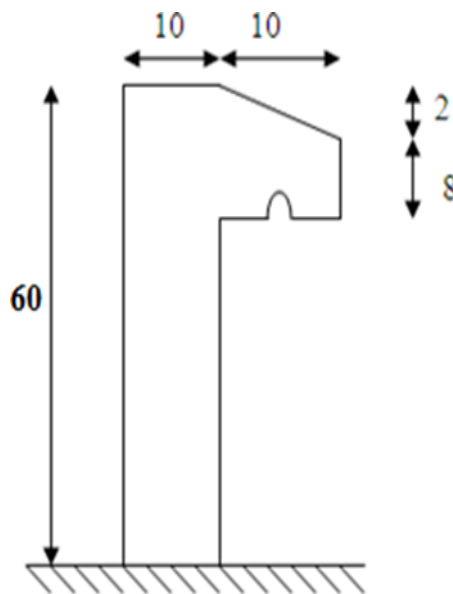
Dimensions de l'acrotère (terrasse inaccessible).
